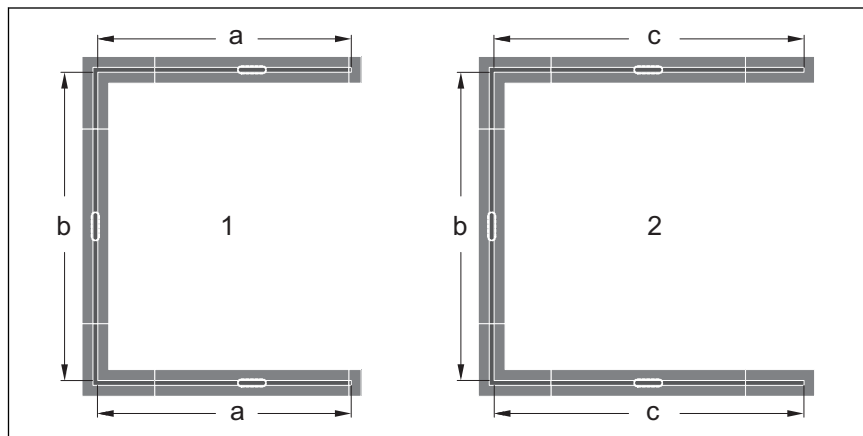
Варианты монтажа с соединительными элементами 90° для П-образной конструкции
